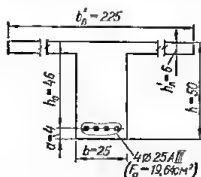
Схема сечения главной балки монолитного ребристого перекрытия.
